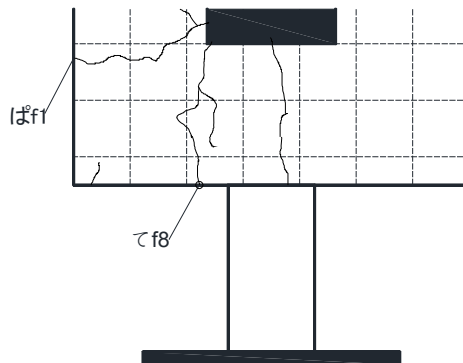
パイルキャップ側面ひび割れ幅測定位置 (試験体 DR-2 +7.0 サイクル 基礎梁側)
